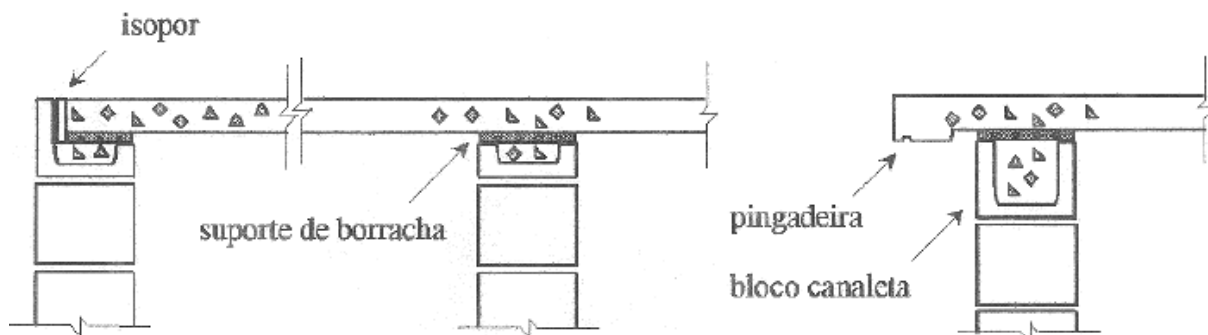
Juntas horizontais de desvinculação da laje com as paredes de alvenaria
